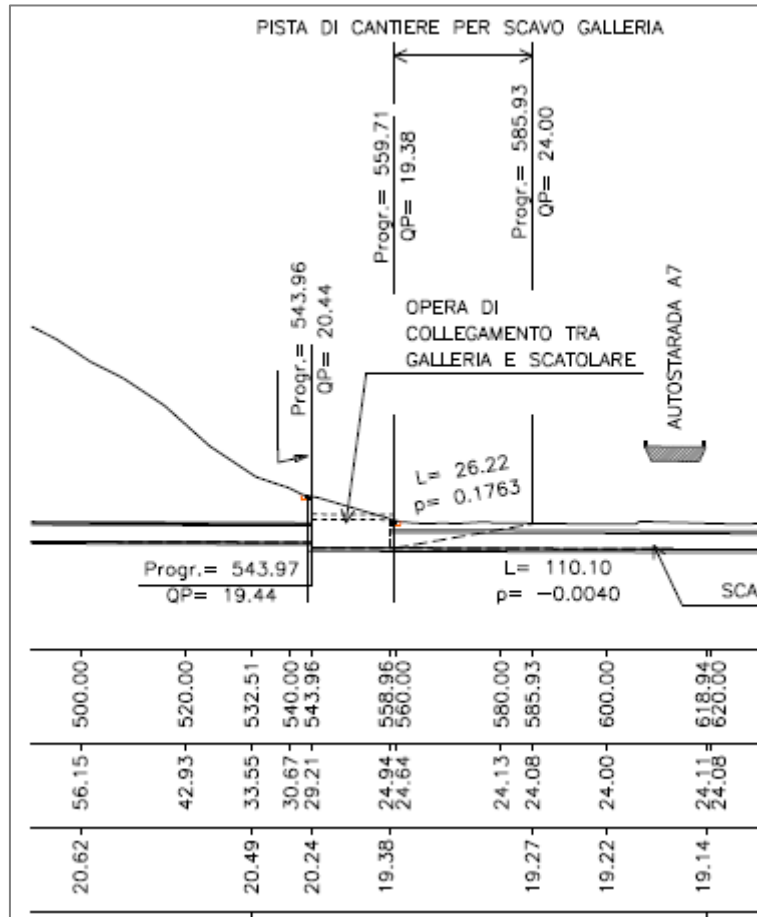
Dettaglio del profilo longitudinale dell'opera di collegamento tra la galleria e lo scatolare
